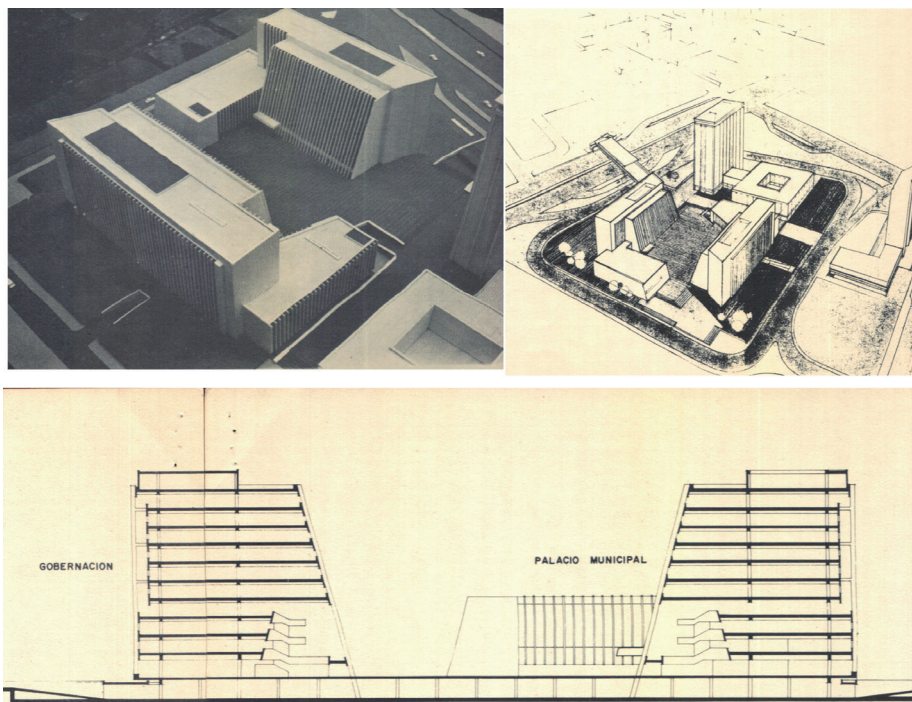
Vista General del proyecto premiado en el segundo concurso para el centro cívico, según los lineamientos estipulados en el Plan Piloto de Wiener y Sert. Fuente: *Revista Ingeniería, Arquitectura, Construcción*, 3, (13), 1975.
